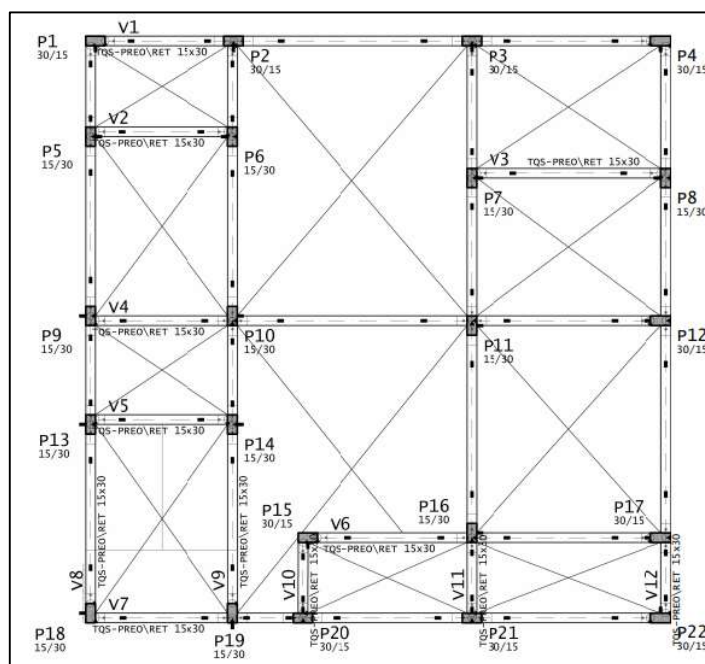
Planta de forma adaptada para o modelo de estrutura em concreto pré-moldado.
